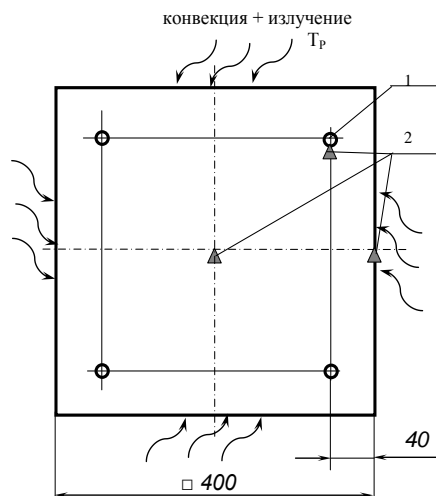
Конструктивная схема сечения испытуемой железобетонной колонны:
